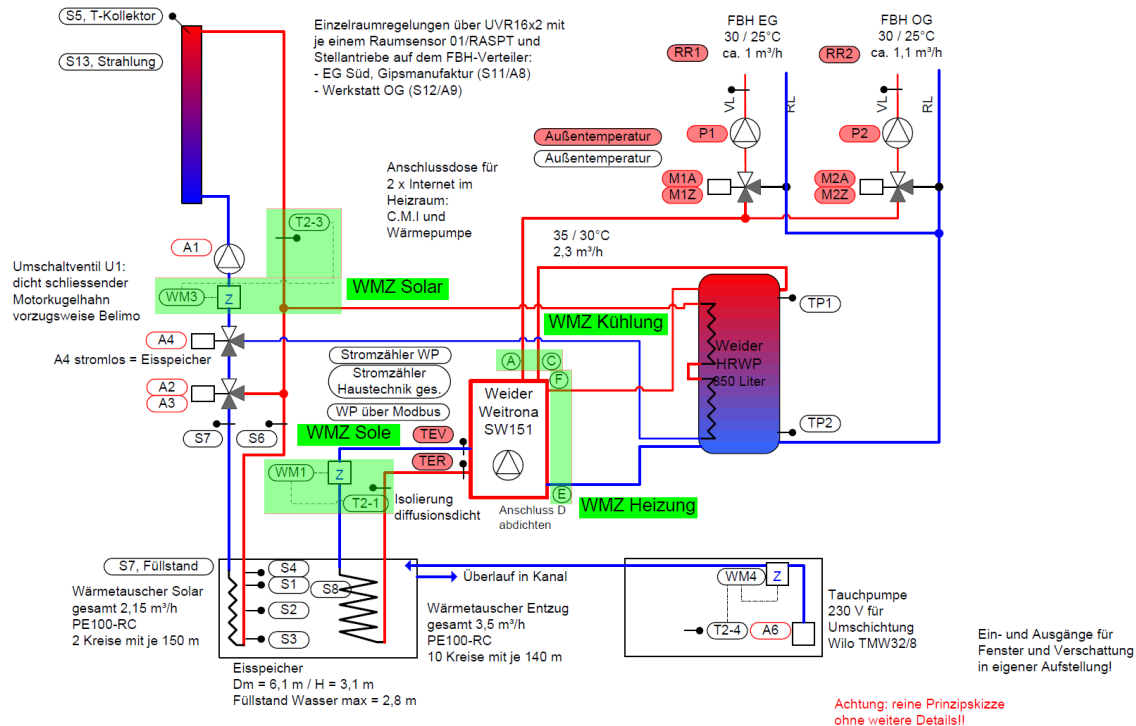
Prinzipskizze Haustechniksystem mit Wärmemengenzähler in Grün [2]
